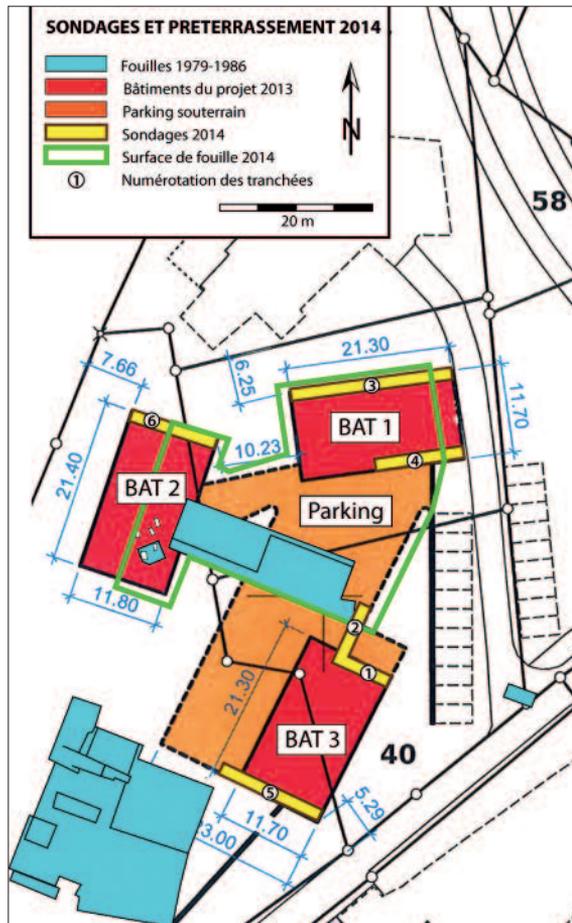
Sembrancher, La Gravenne, chantier Crettaz Polet 2014 (CP 14). Plan de situation du projet de construction, des sondages préventifs et du terrassement.
